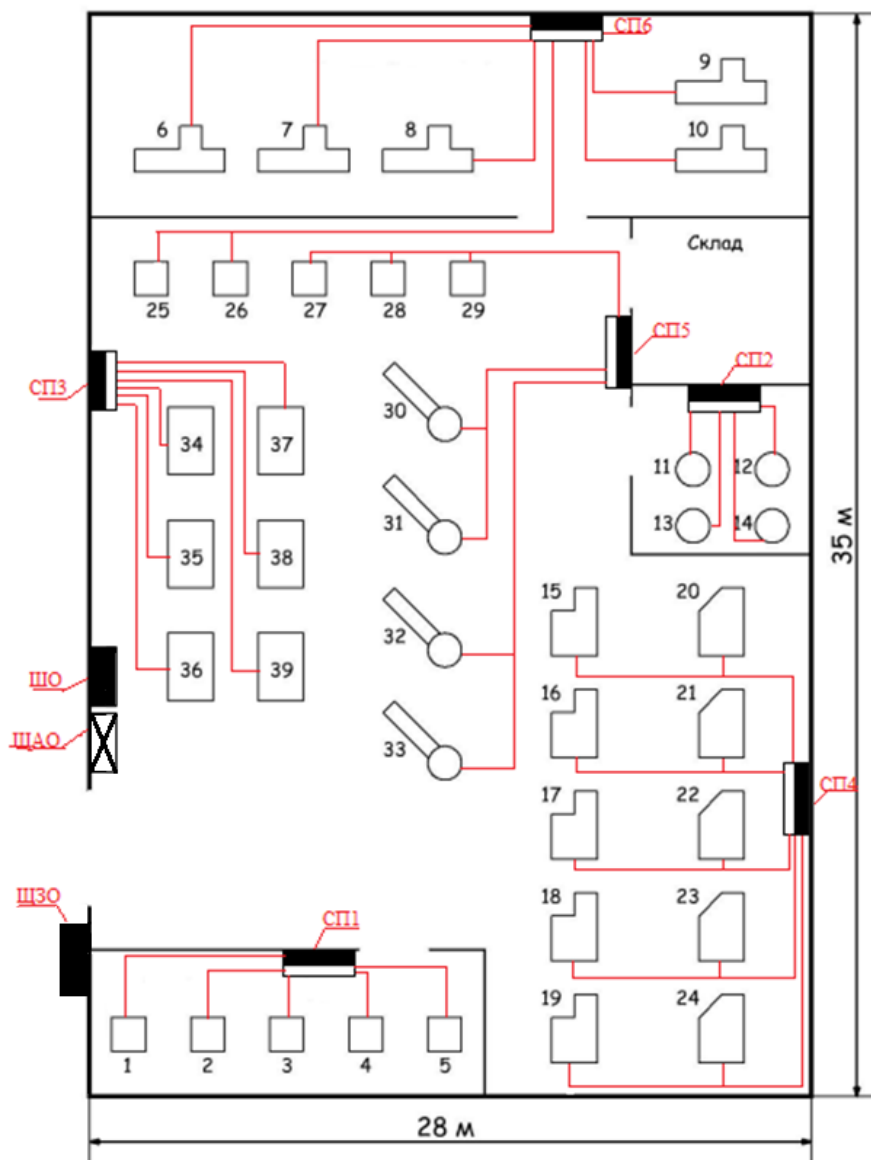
План розміщення ЕП цеху обробки корпусних деталей
